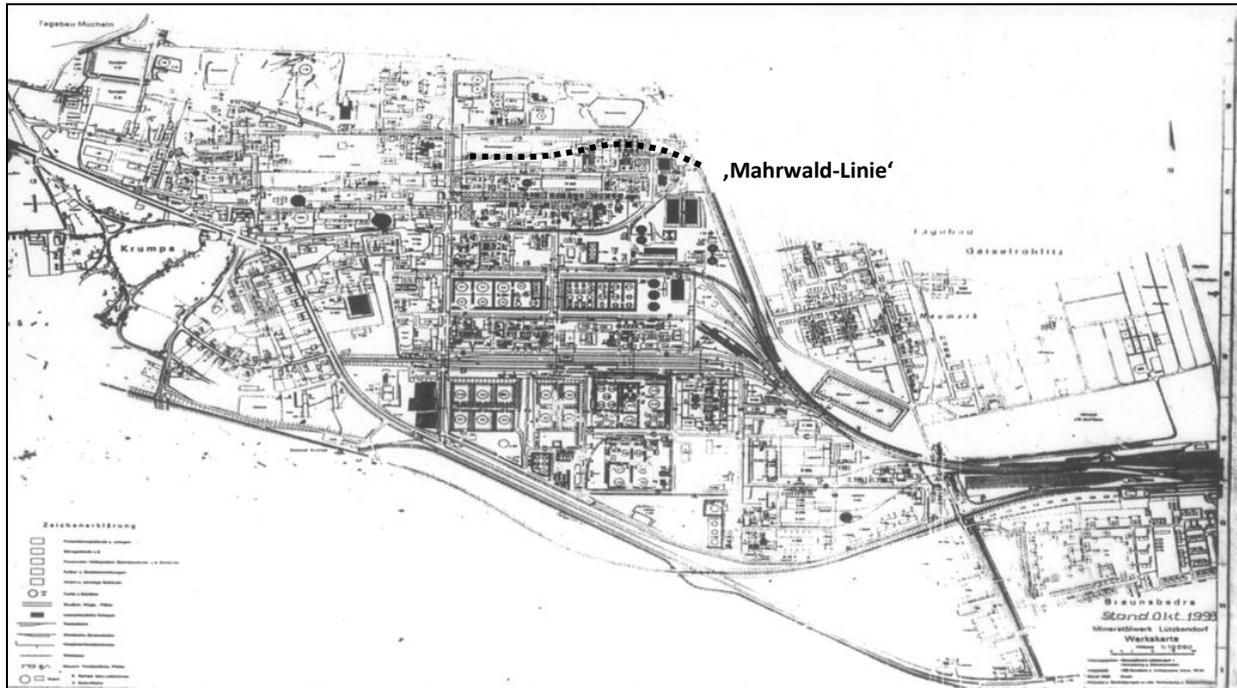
Gesamtlageplan Mineralölwerk Lützkendorf (Stand: 1933, mit nachgetragener ‚Mahrwald-Linie‘)
